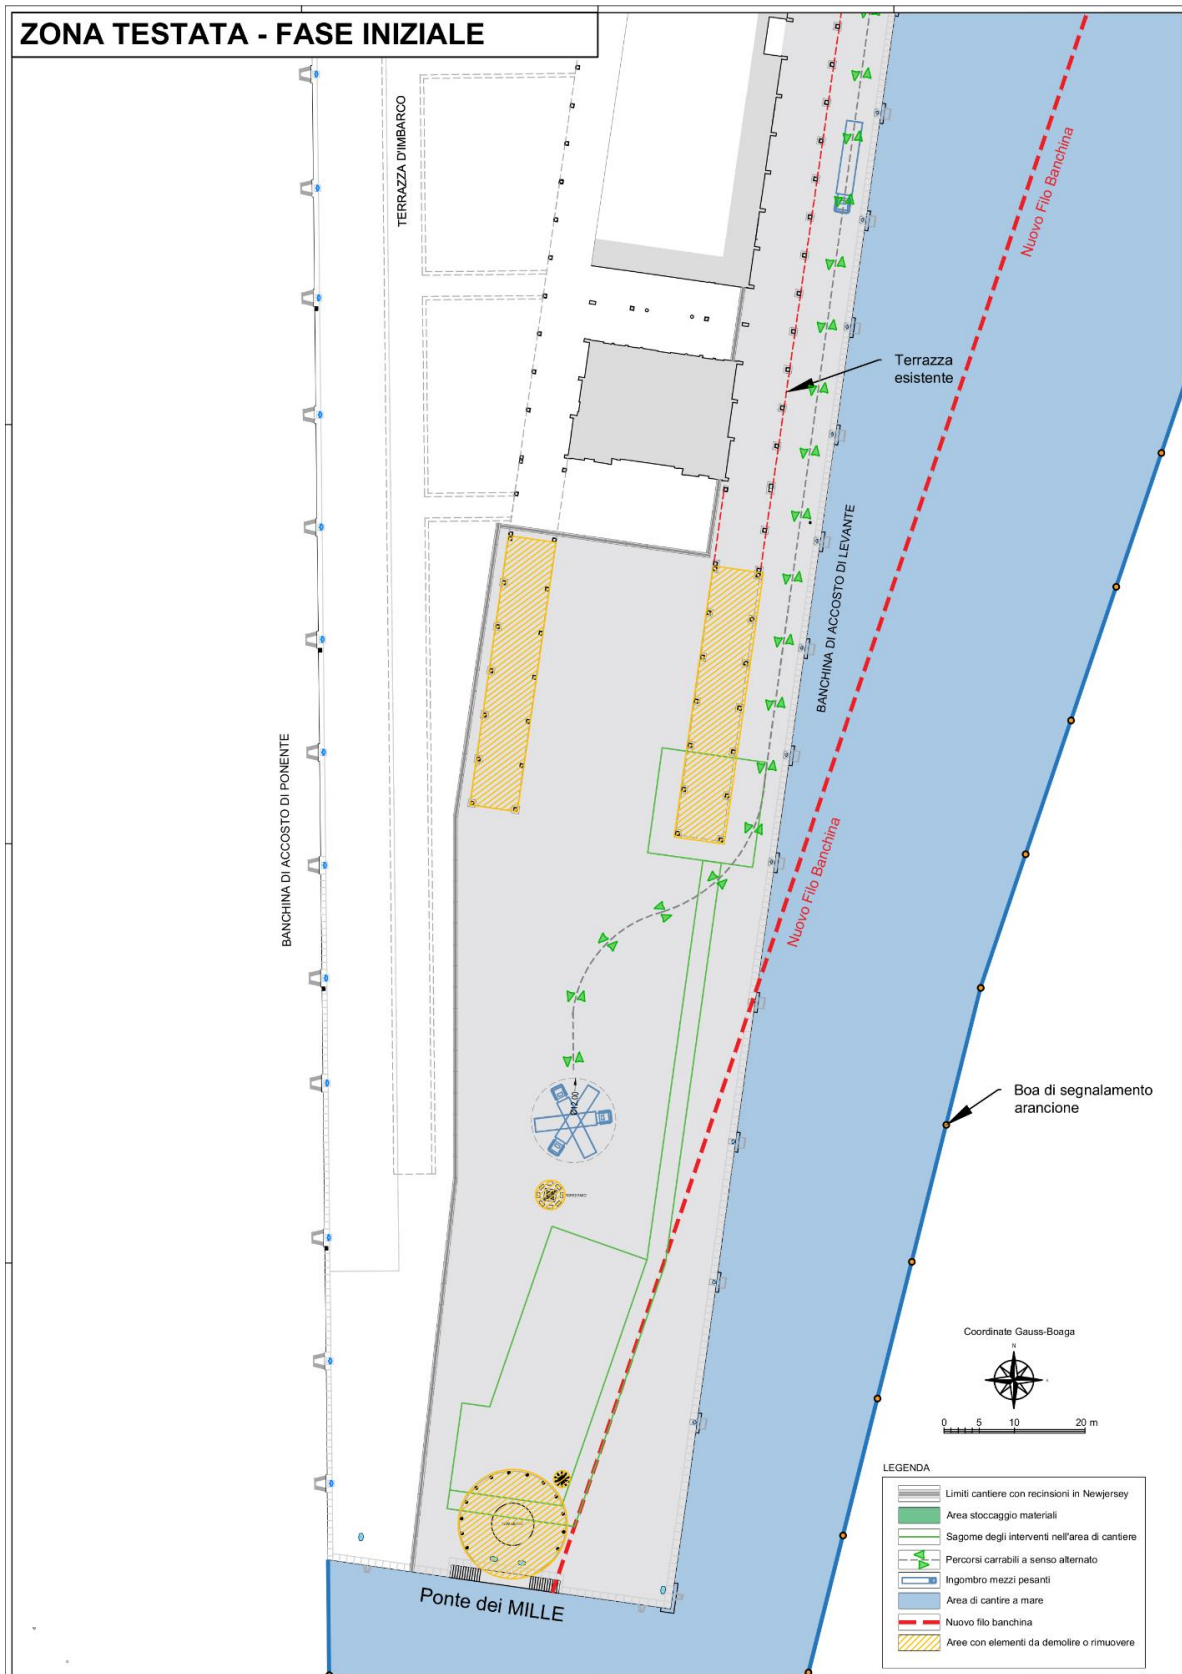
Dettaglio area testata pontile fase iniziale- Planimetria del layout generale di cantiere
